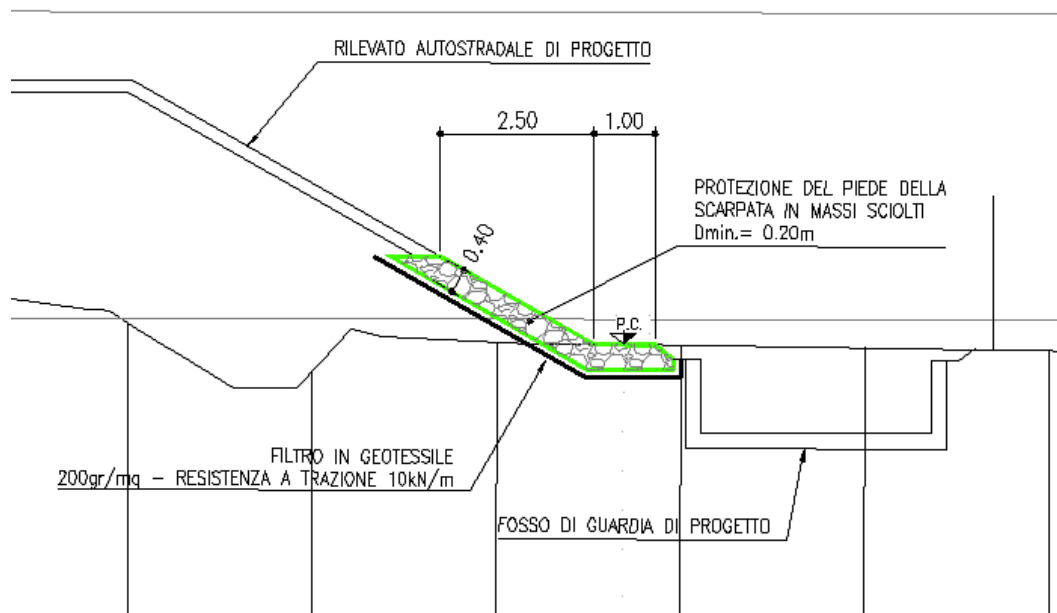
Sezione di progetto del rivestimento del rilevato autostradale
